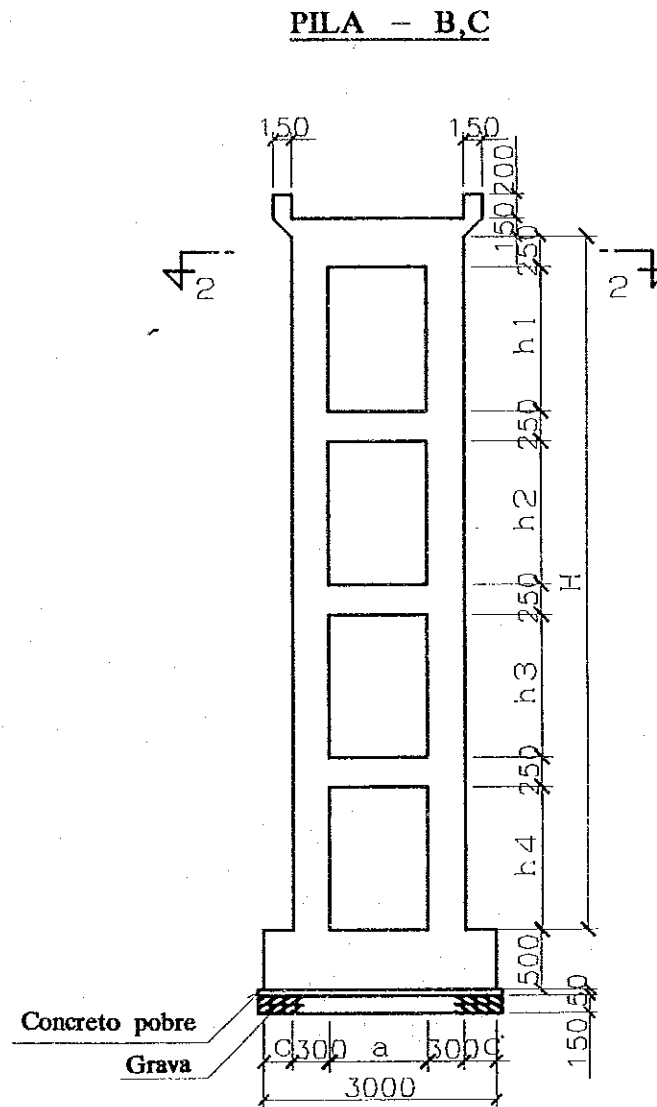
PLANO GENERAL DE PUENTE CANAL (2/2)
